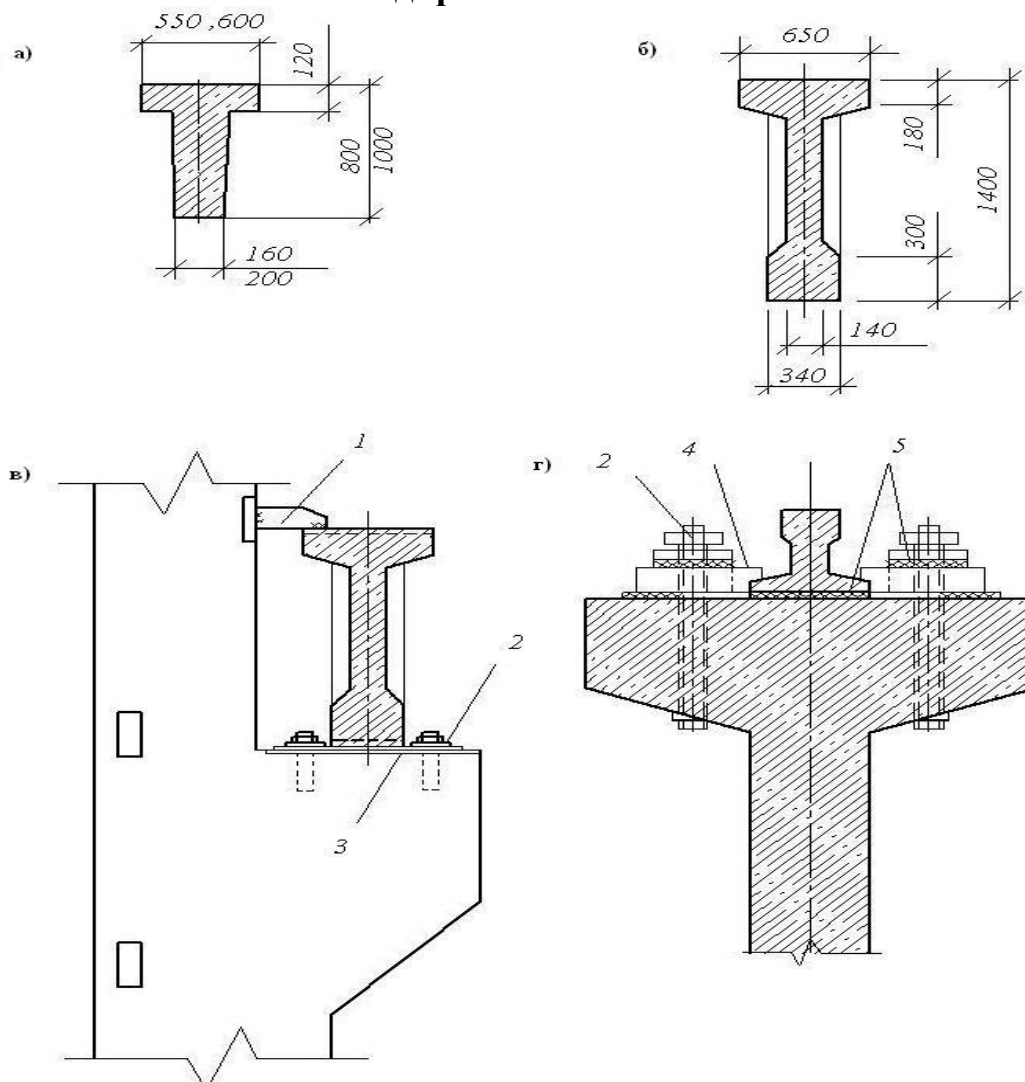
Железобетонные подкрановые балки: а – при шаге колонн 6 м; б - при шаге колонн 12 м; в – крепление подкрановой балки к колонне; г – крепление рельса к подкрановой балке; 1- стальная пластина; 2- болт; 3- опорный стальной лист; 4- стальная лапка; 5- упругие прокладки
